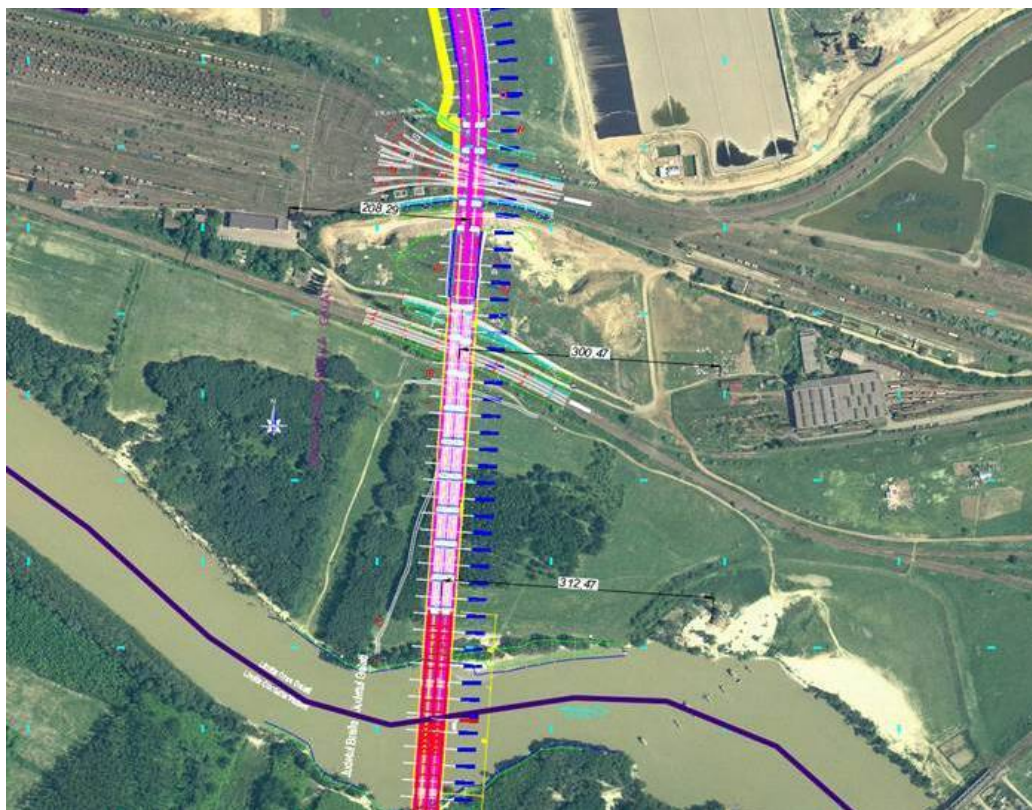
Amplasarea zonei de la km 11+600 în raport cu locuințele / zonele construite
